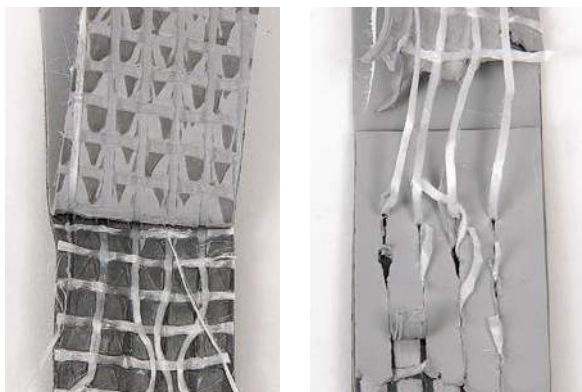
Когезионный разрыв сварного шва
